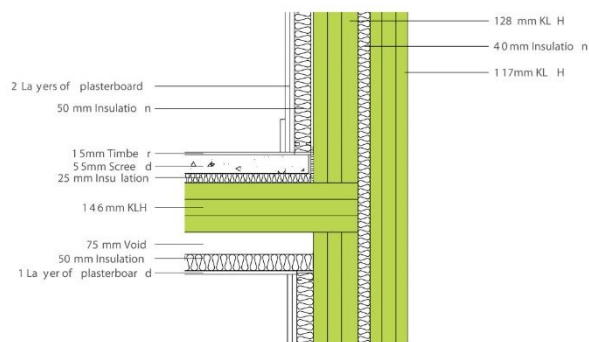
Detalle unión de Paneles CLT y fundaciones. Plataforma de Arquitectura.
